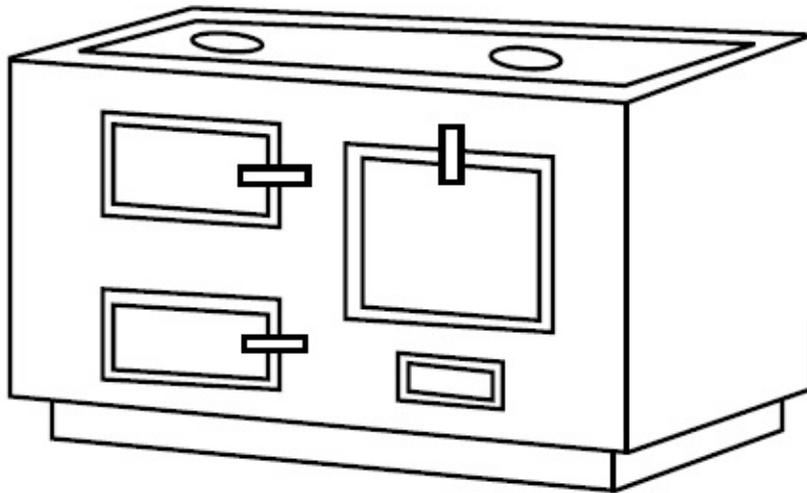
Кухонная плита с равномерно обогреваемой духовкой: 1 – поддувало; 2 – топливник; 3 – духовка; 4 – чистка
